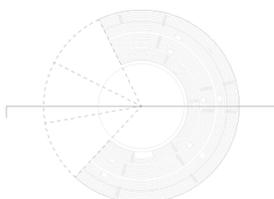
Propuesta Arquitectónica Plan Masa. Creada por el autor
